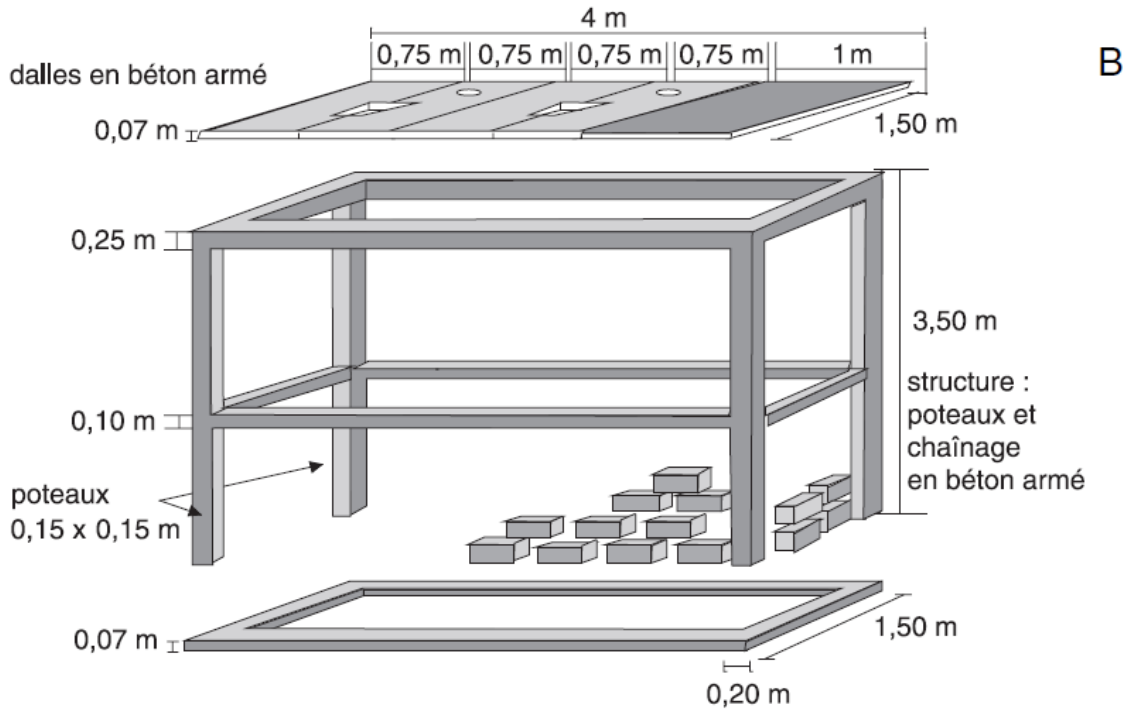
Fosse et fondations de toilettes à 2 postes. B : dalle sur fosse avec revêtement de maçonnerie (ACF – 2006)
